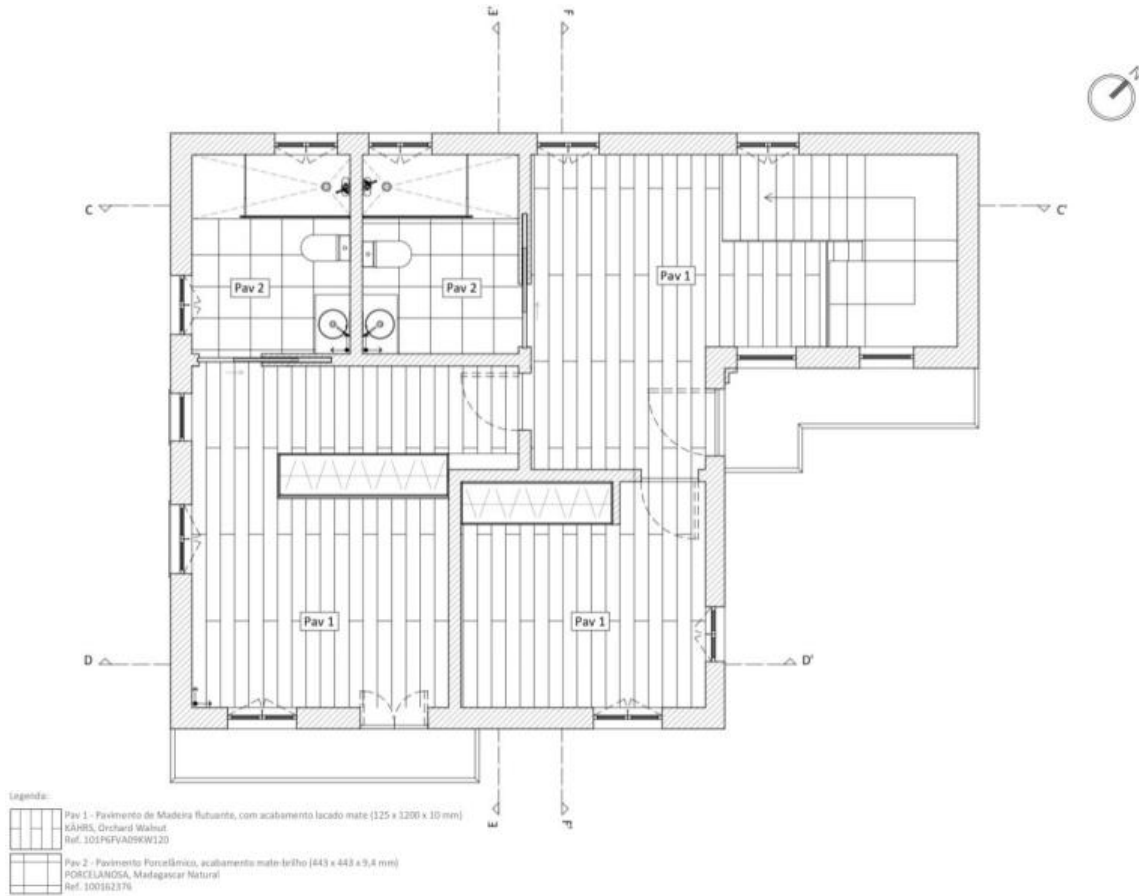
Planta de Pavimento, Piso 1. Fonte: Autor
